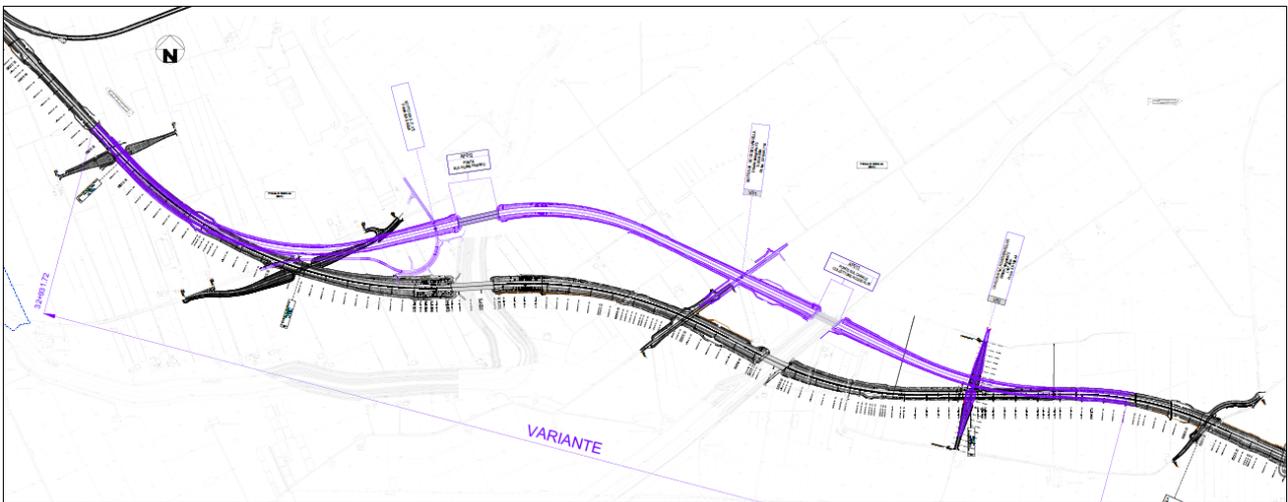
planimetria tracciato progetto definitivo (nero) e variante ansa Panaro (viola)
